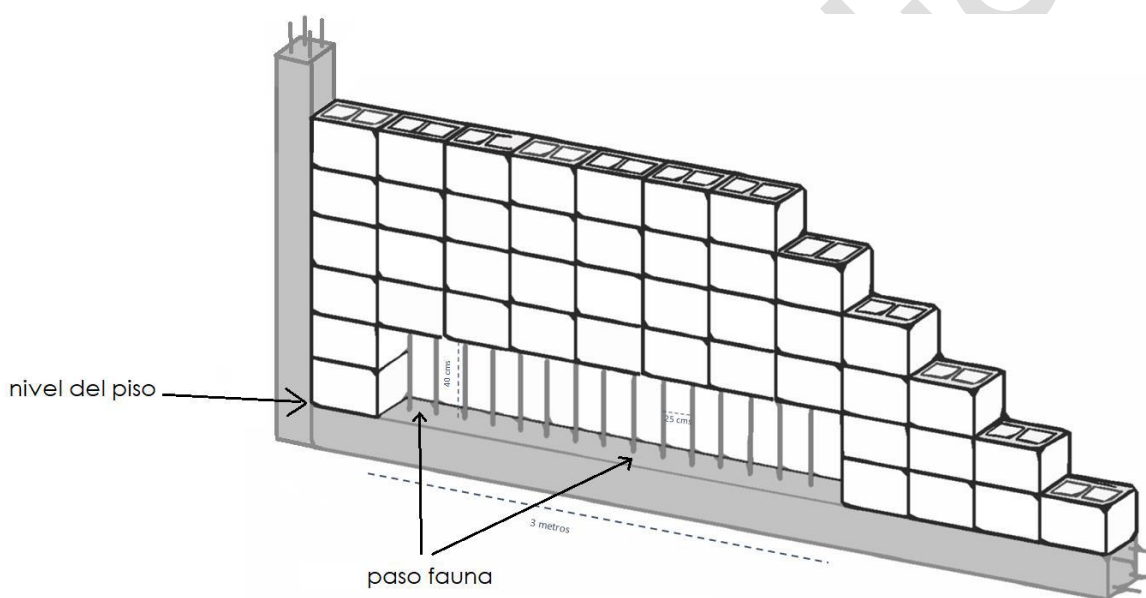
32. Barda perimetral del proyecto Senderos Poniente.
